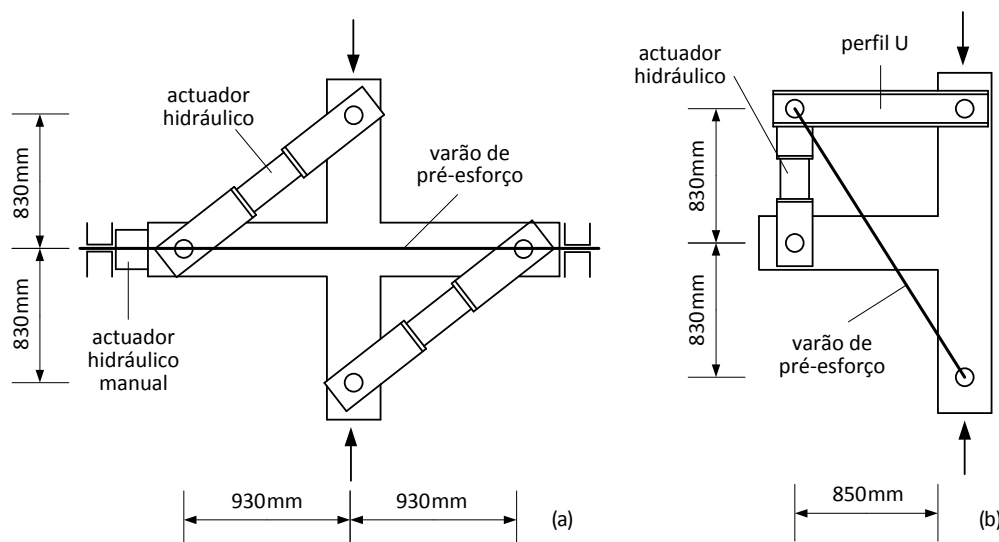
Sistema de aplicação de cargas adoptado por Roeser [2002], (a) ligação viga-pilar interior, (b) ligação viga-pilar de extremidade.
